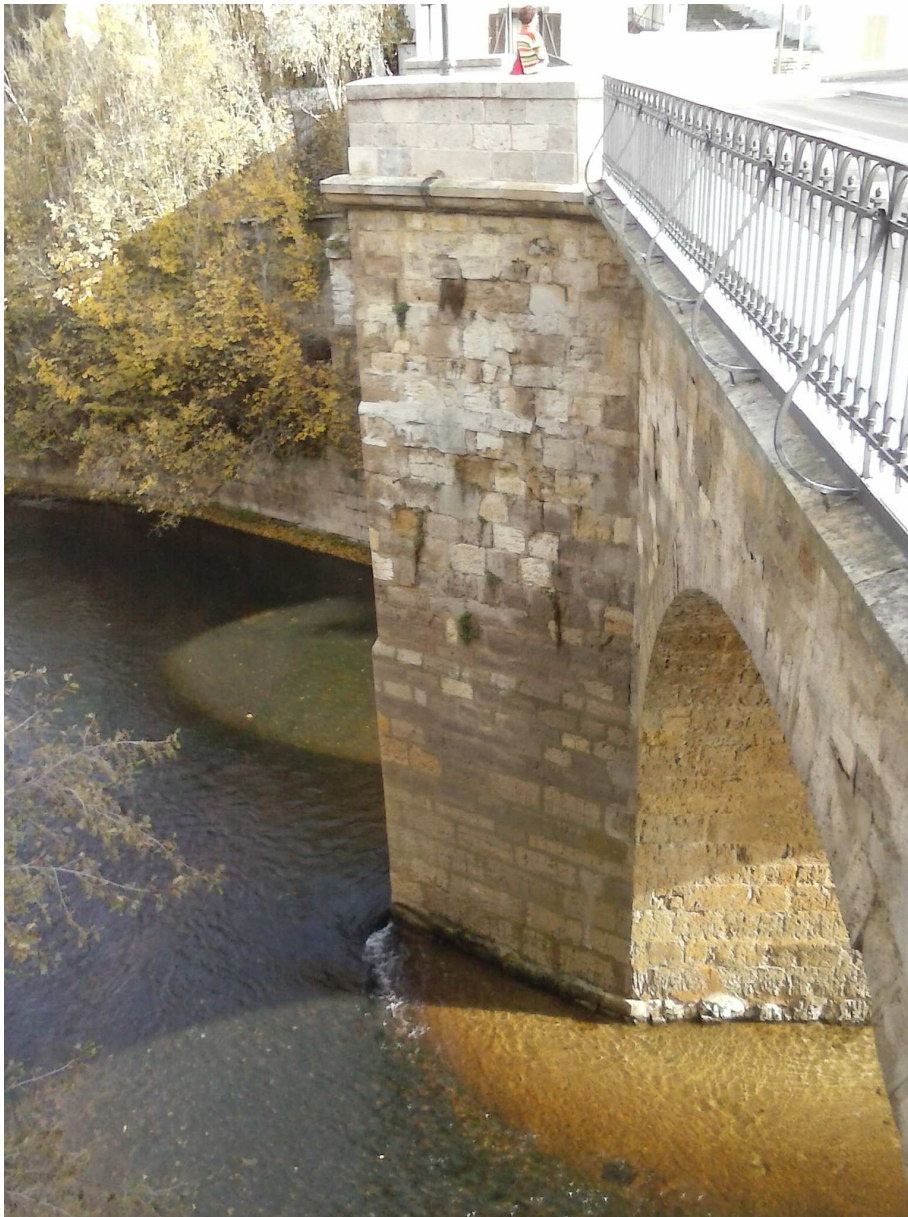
Foto de pila con tajamar triangular en puente en Carrión de los Condes.
